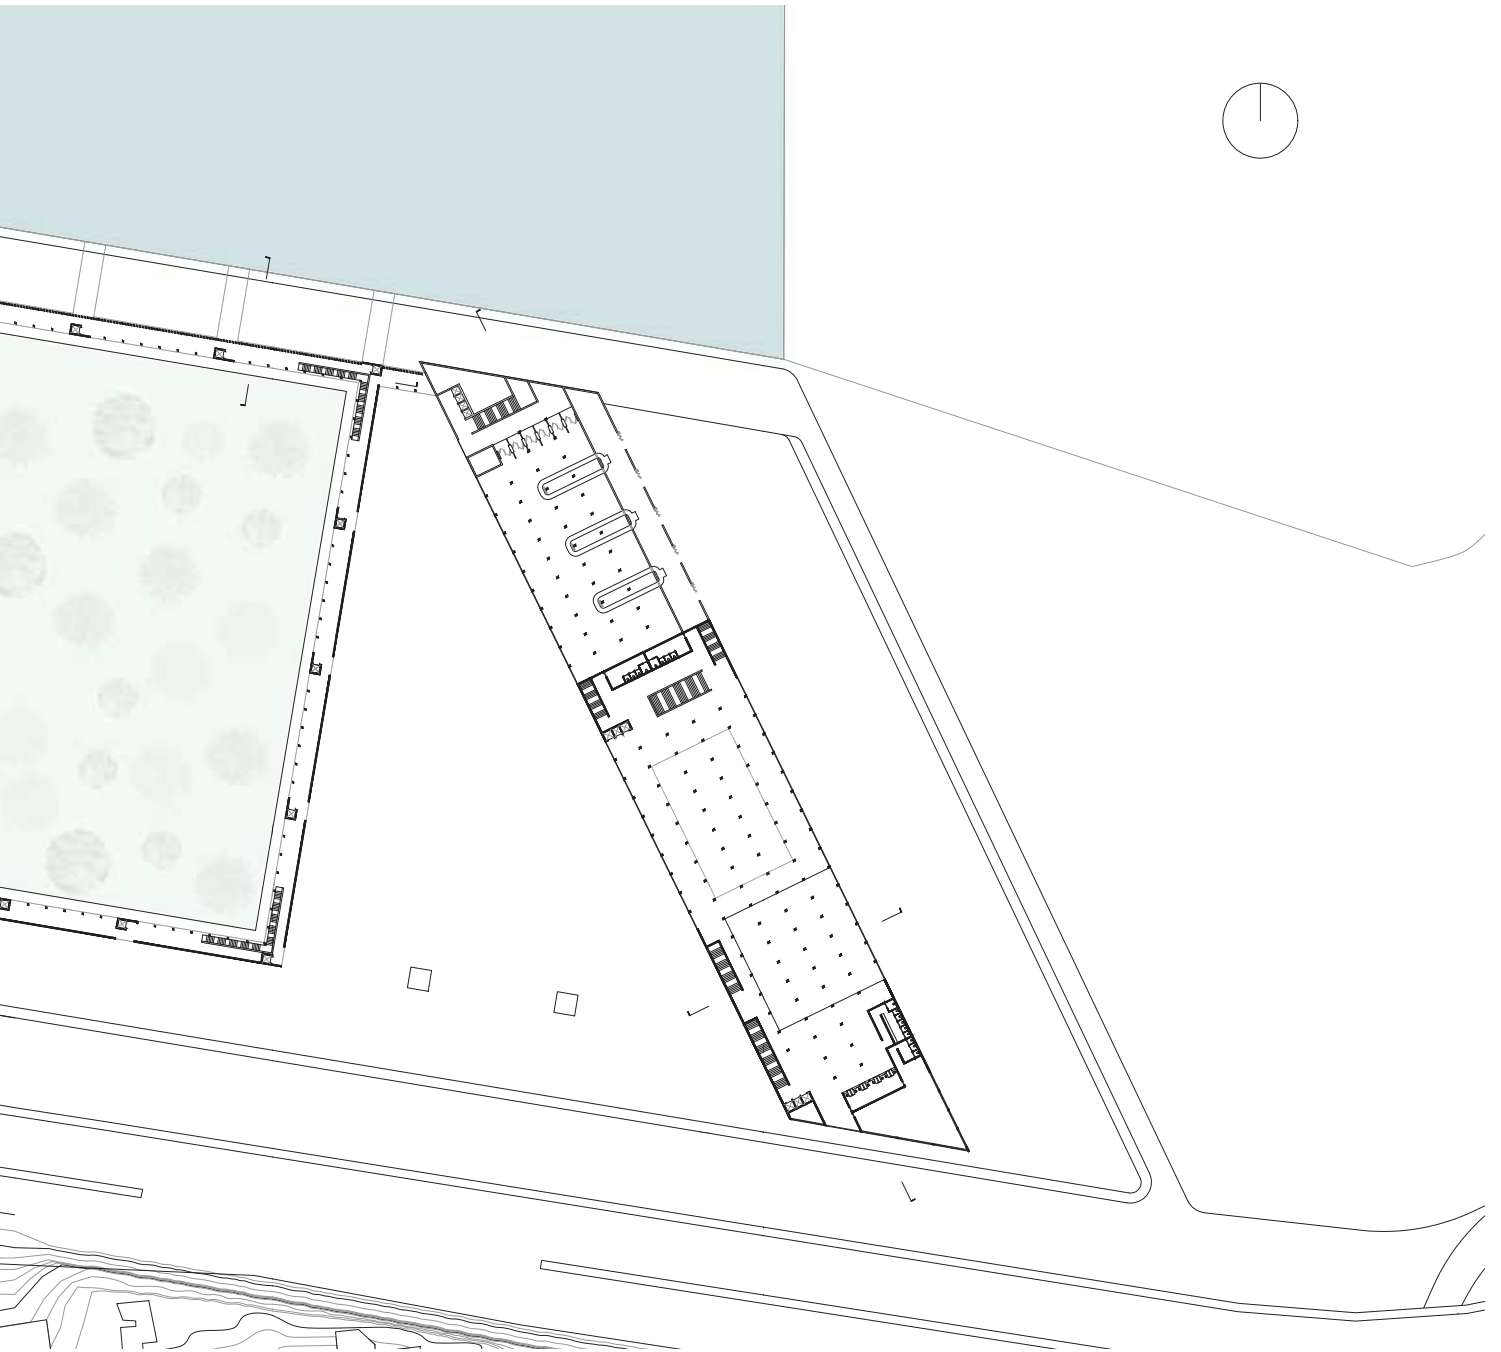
PLANTA DO PISO 1 DO TERMINAL
